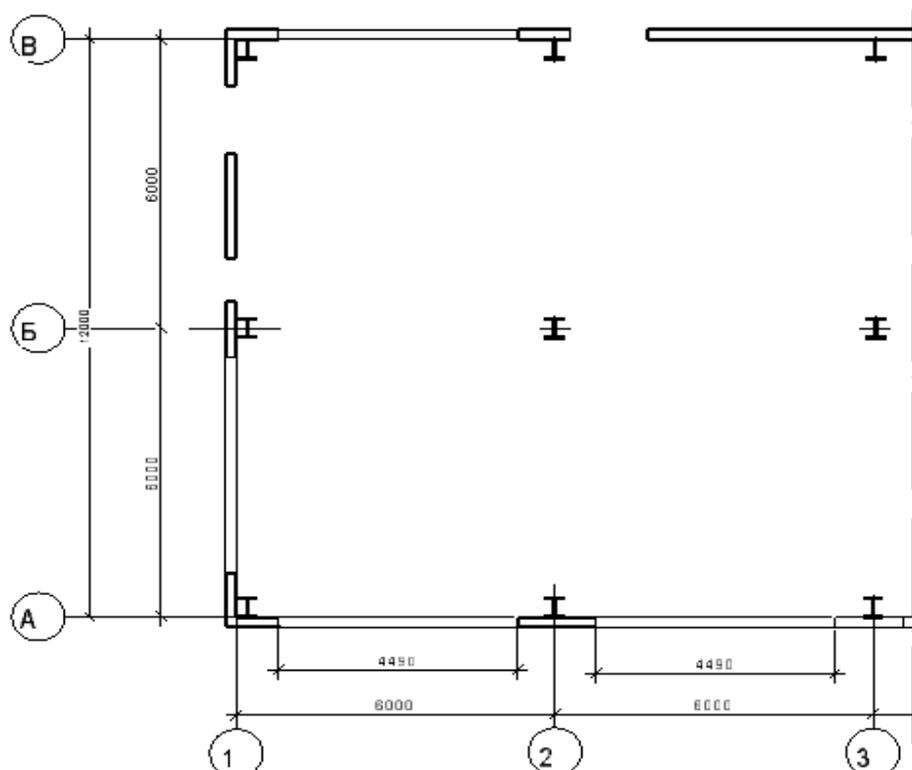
План здания в осях «А–В», «1–3»
